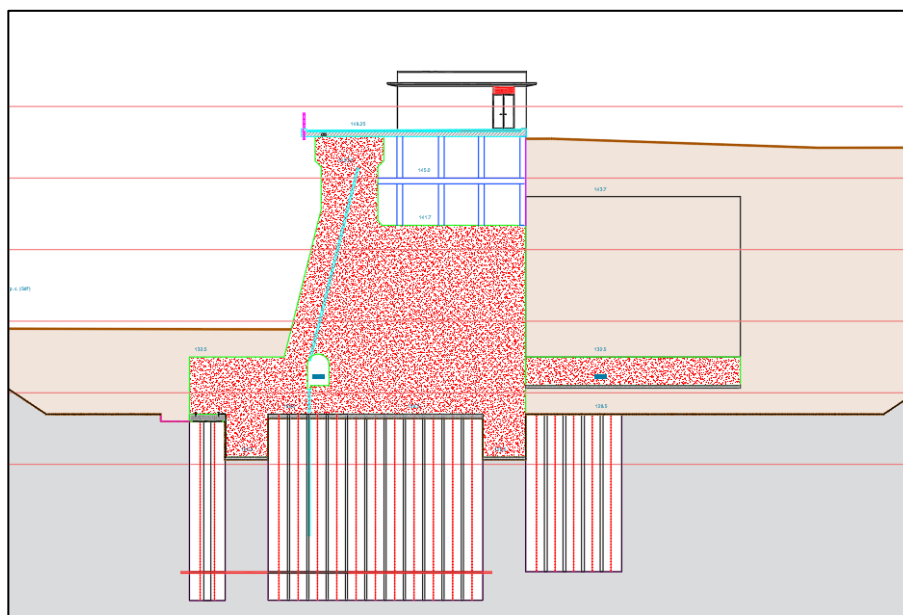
Sezione trasversale concio intermedio in corrispondenza del muro di immersione nel rilevato arginale
